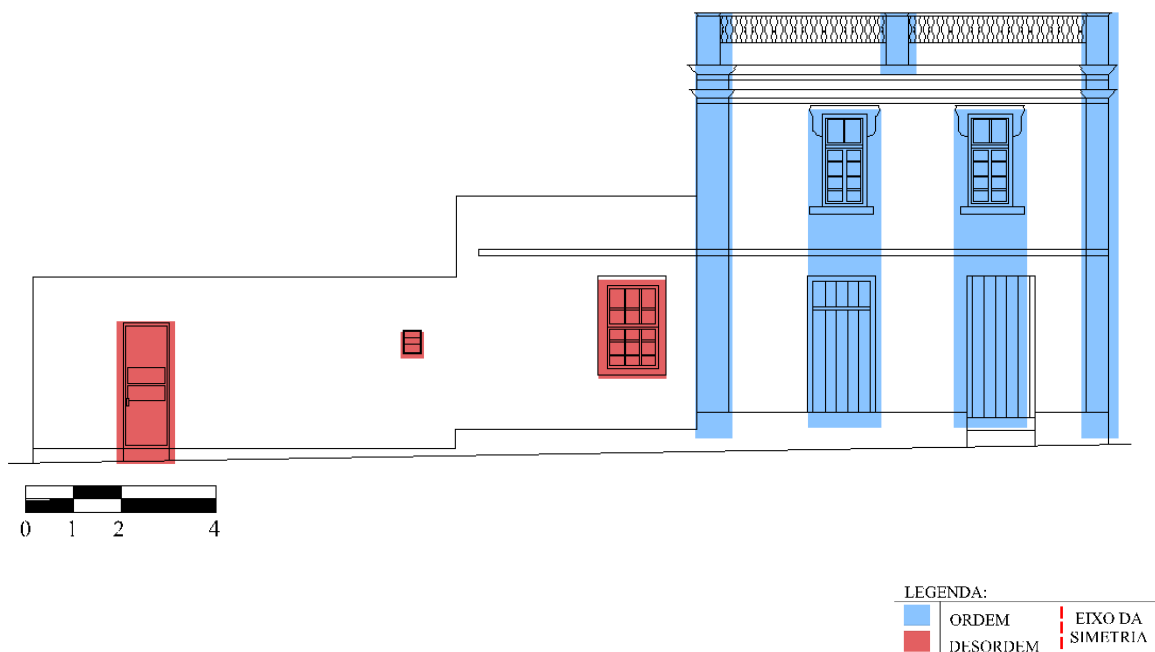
Fachada Edificação 06 da cena B – Sobrado 1920 (Estudo de ordem e complexidade)
